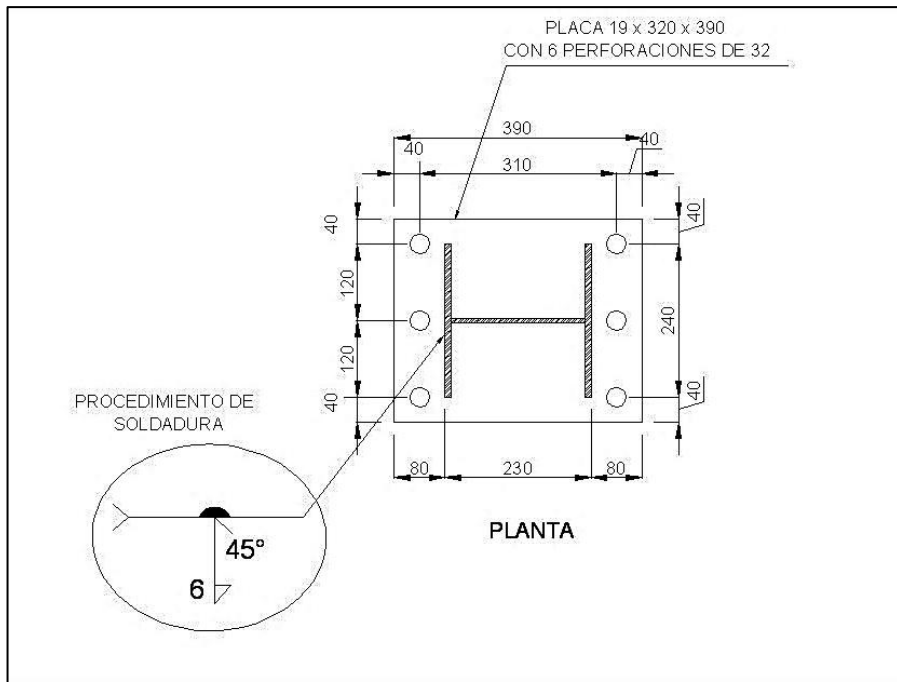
Barrenos y soldadura en la placa base de una columna
